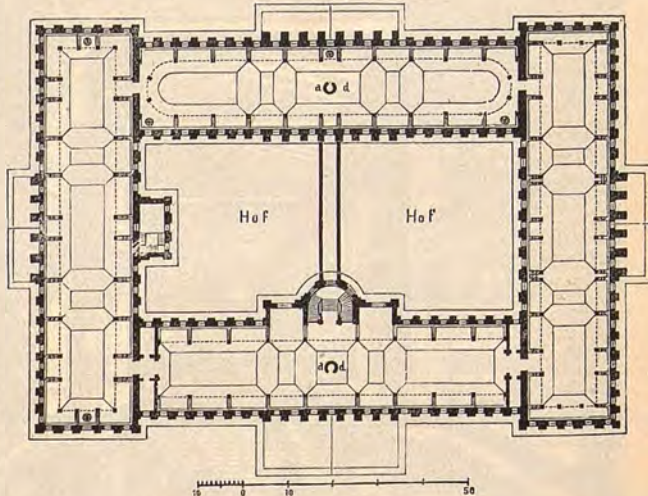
a, b. — Museo dei brevetti, a Washington (arch. Cluss e Schulze).
